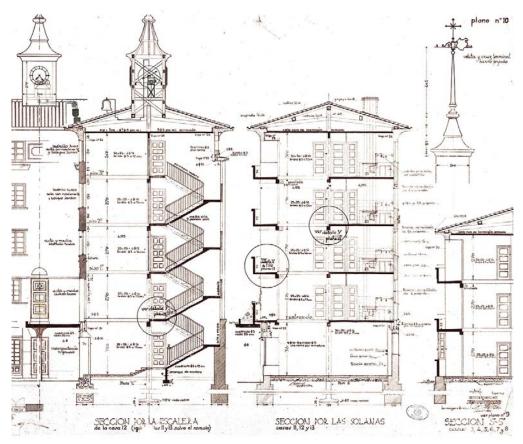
Sección constructiva del Grupo Legazpi (1947). Este plano de Domingo Unanue resulta sin duda uno de los planos de construcción más elaborados de entre los conservados en archivo.
